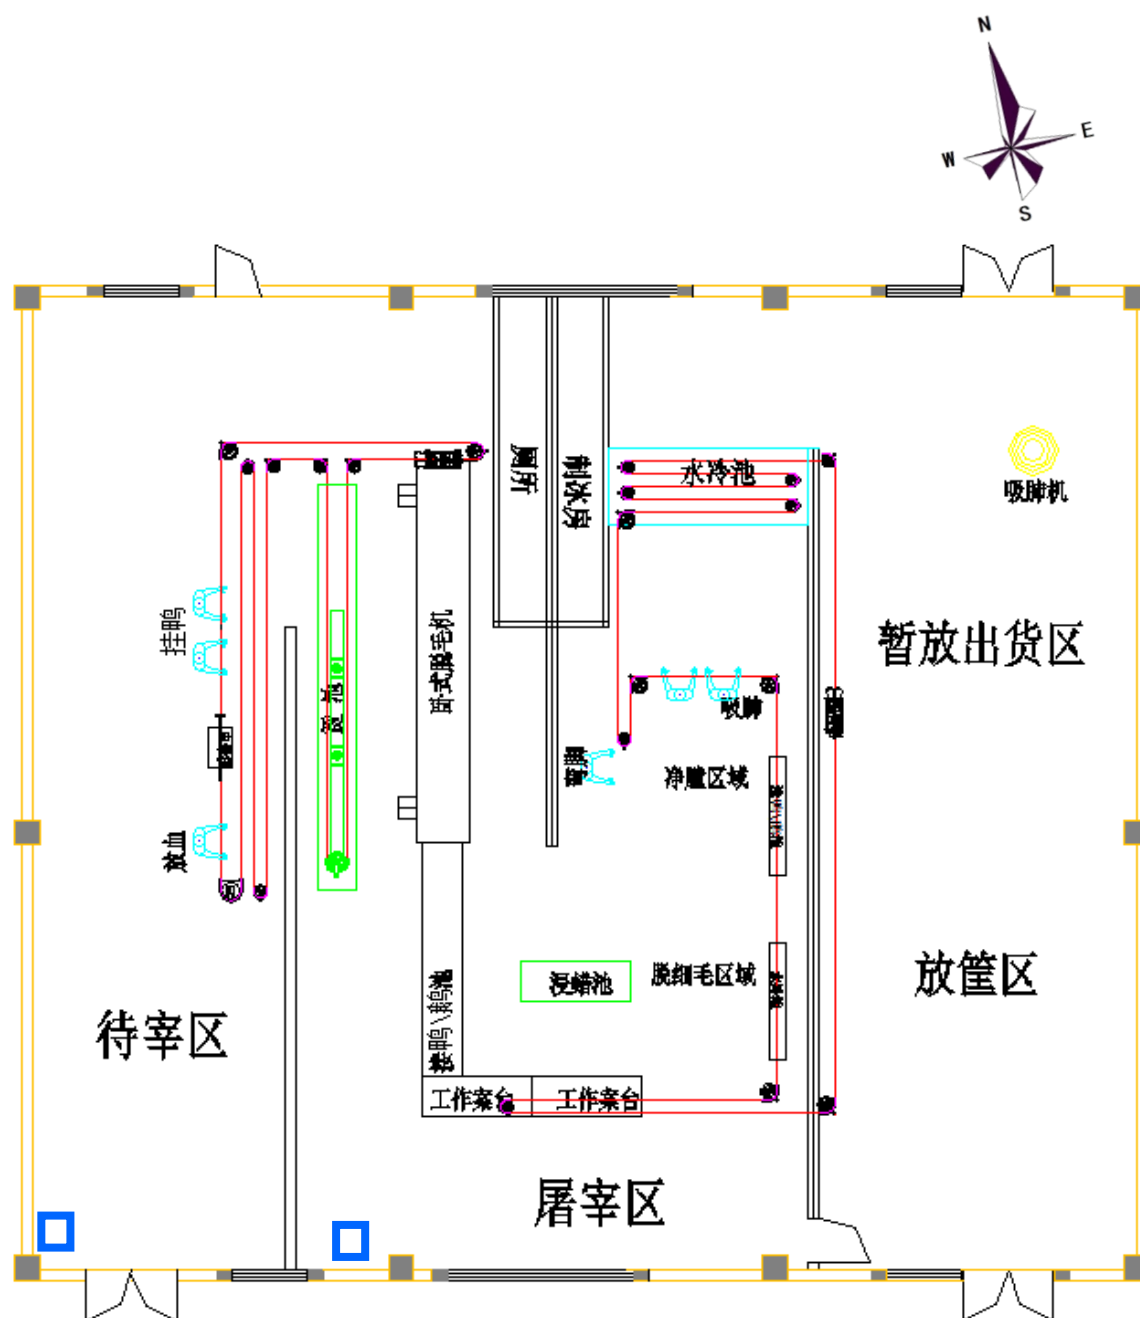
屠宰间(2#)~（4#）平面布置图
